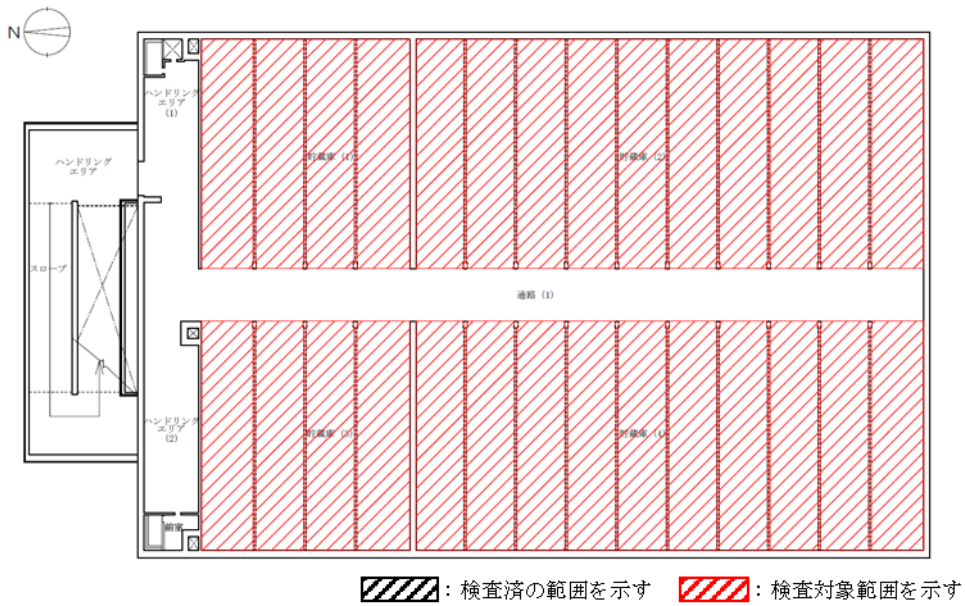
貯蔵能力を確認する範囲を示した図 5階平面図 (6 / 6)
